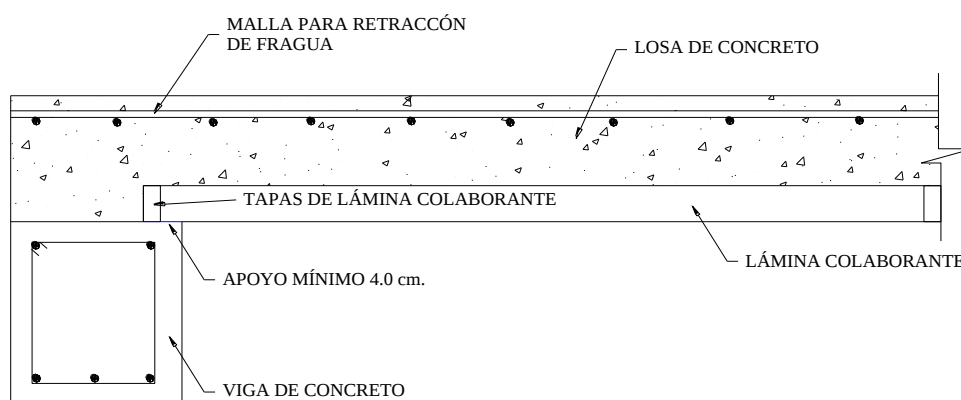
Detalle típico del apoyo de la lámina colaborante sobre una viga.
